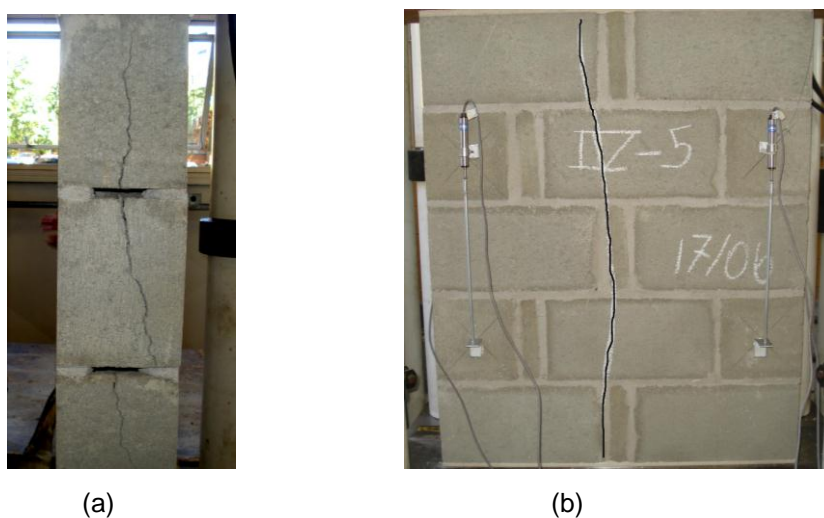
Vista lateral (a) e vista frontal (b) da mini-parede com argamassamento lateral com rapaduras (Série IV).
